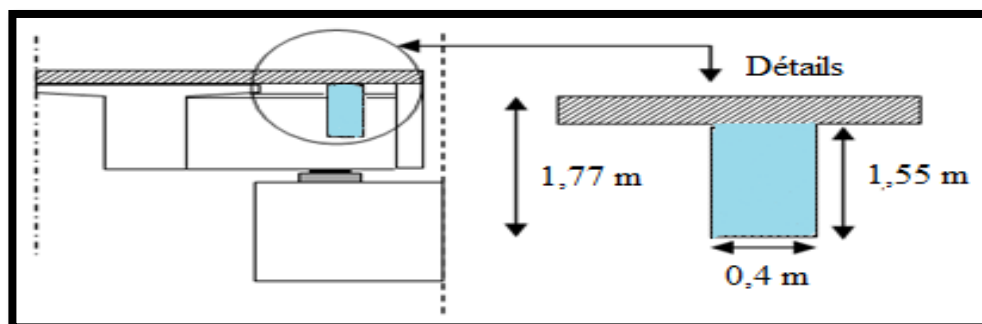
Coupe longitudinale de l'entretoise.
